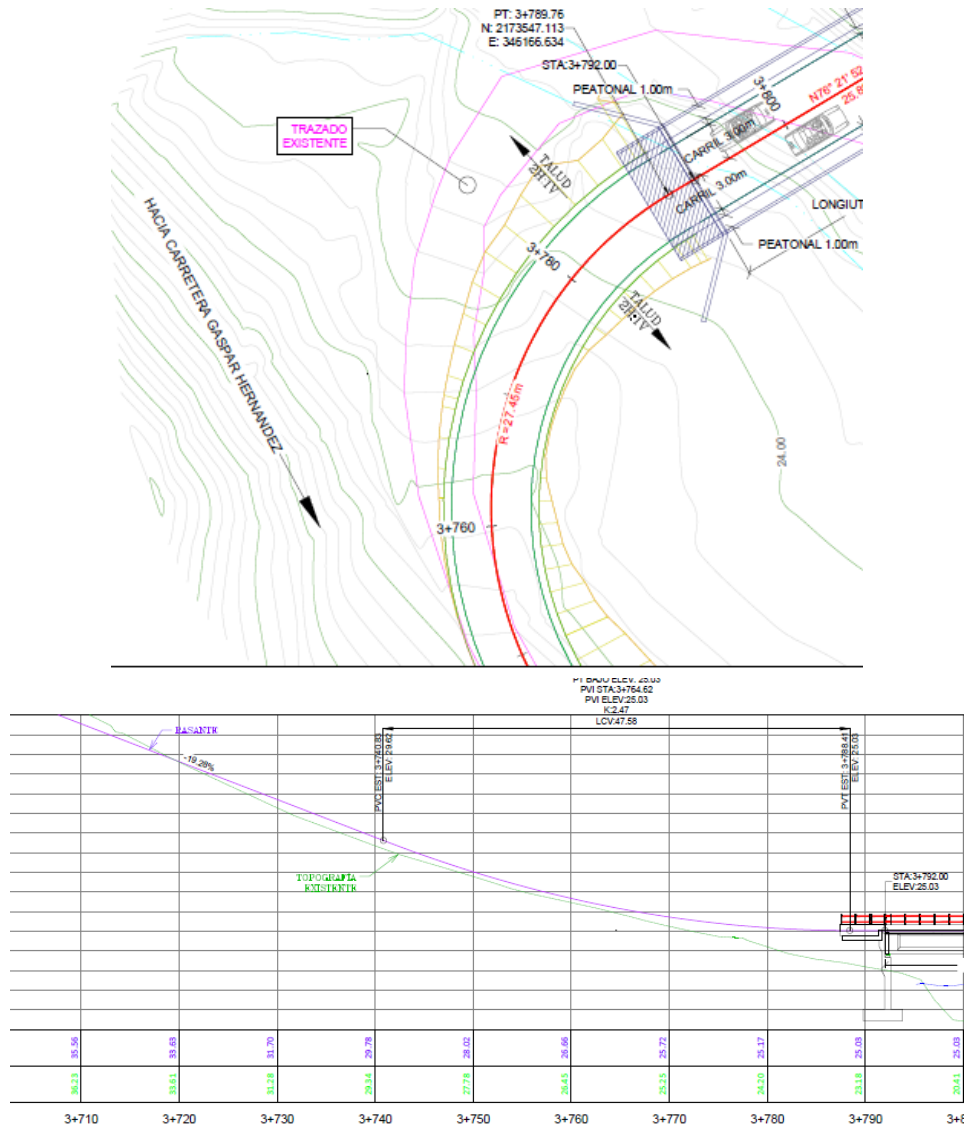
Planta y elevación del tramo de salida del puente sobre el Arroyo Jamao
